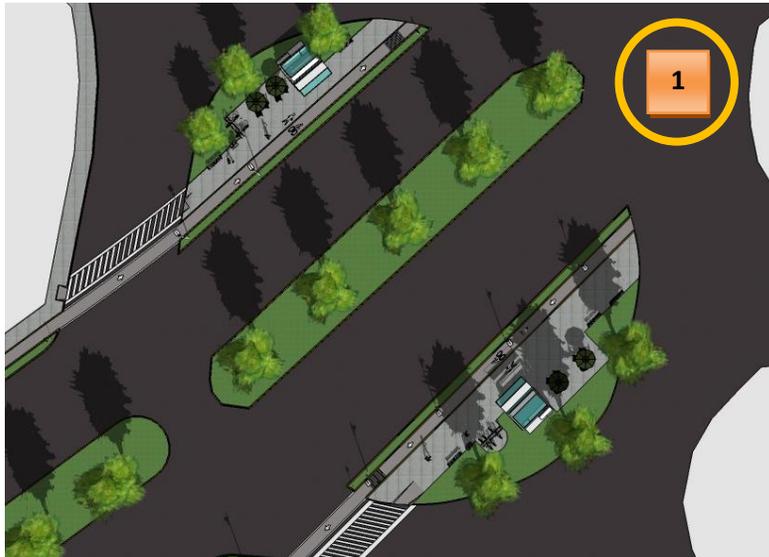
Intersección del Boulevard los Héroes y 21 Calle Poniente, vista en planta.
